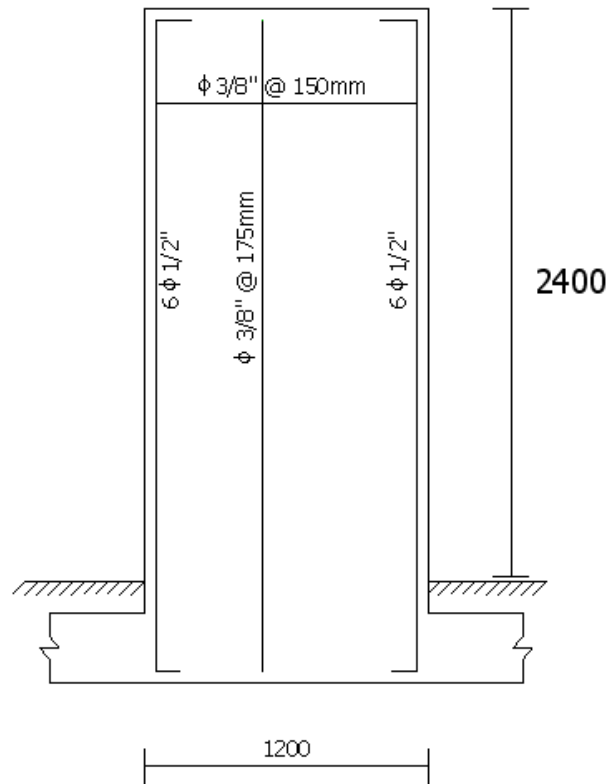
Diseño de muro sin aberturas (medidas en mm)
